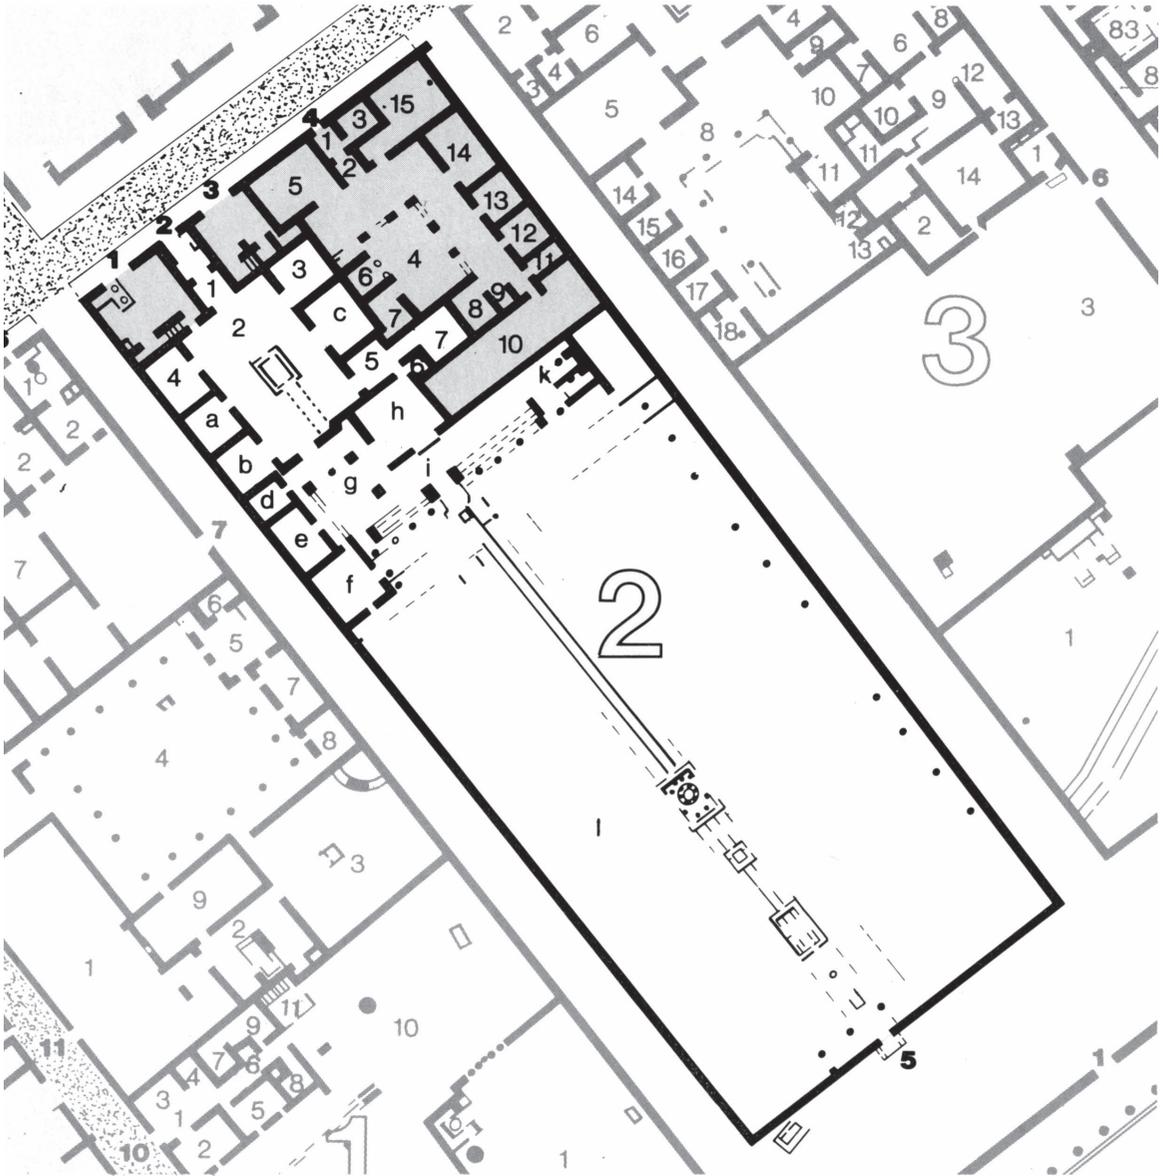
Rekonstruierter Grundriss der Casa di Octavio Quarto, Planzeichnung: Gabinetto Fotografico Nazionale
